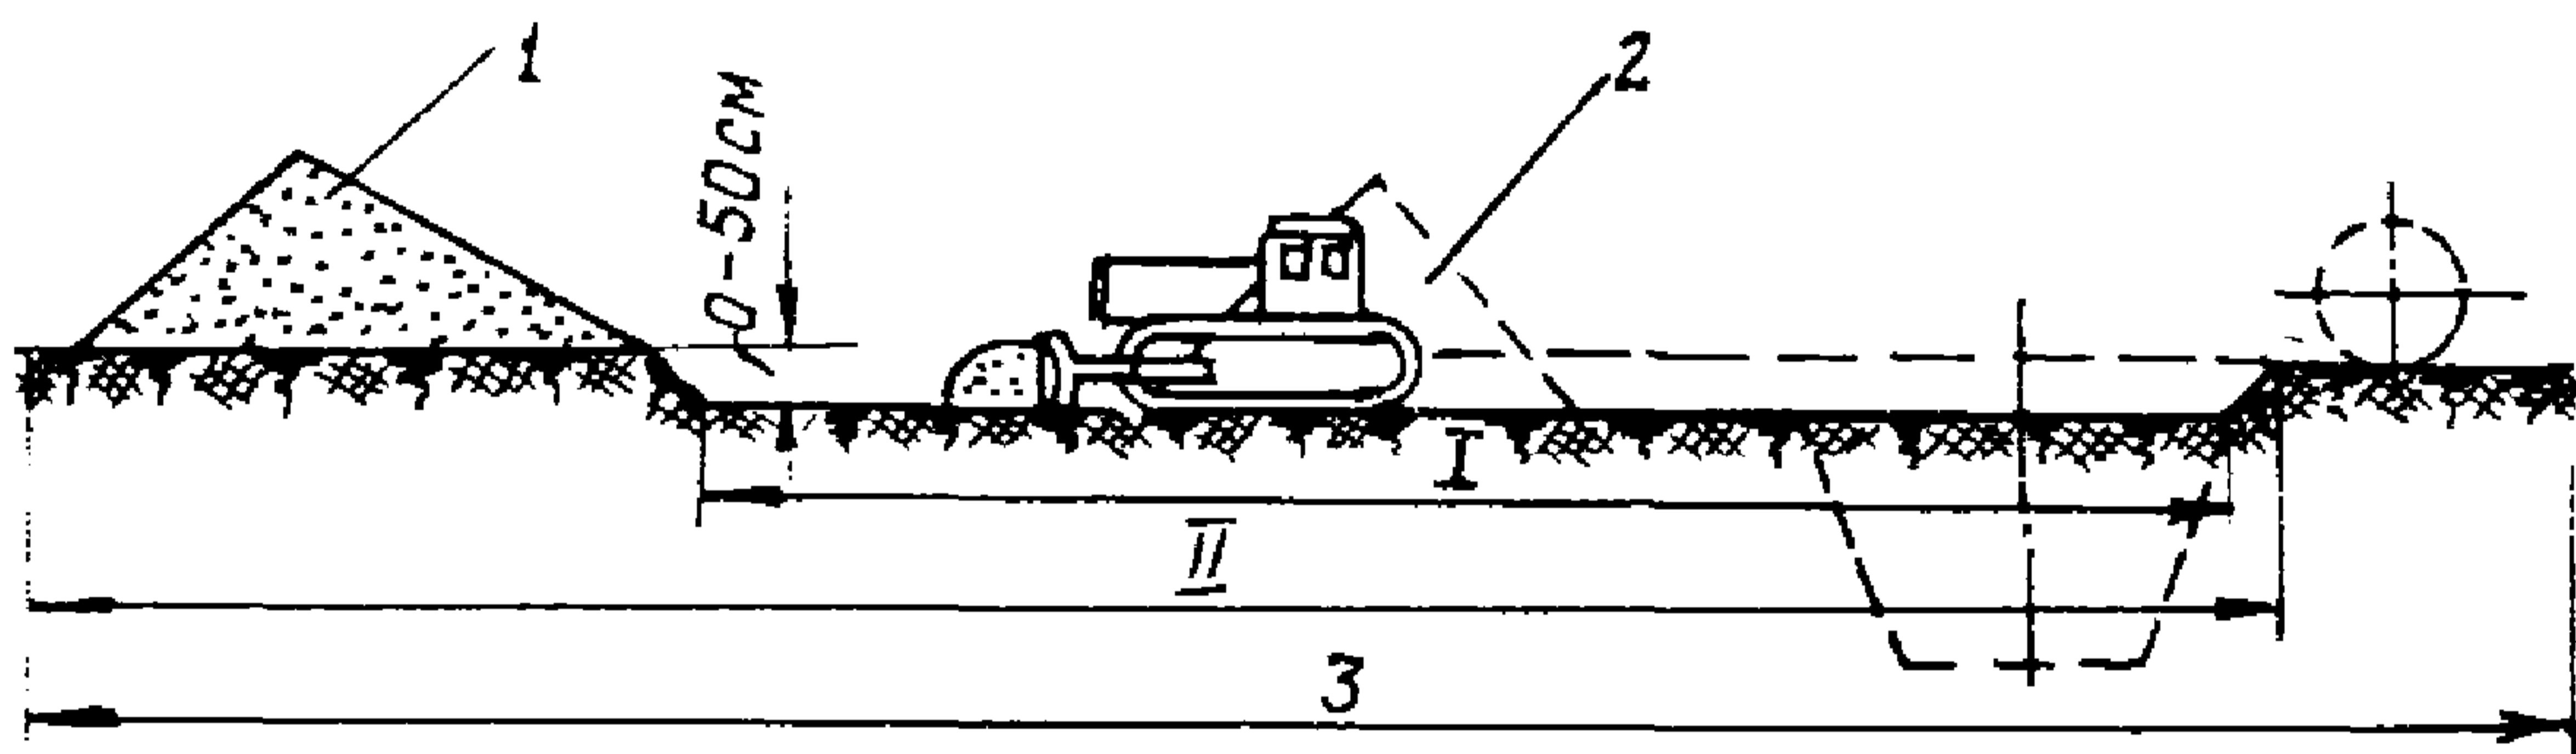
Схема разработки и перемещения гумусового слоя грунта бульдозером при технической рекультивации строительной полосы:
